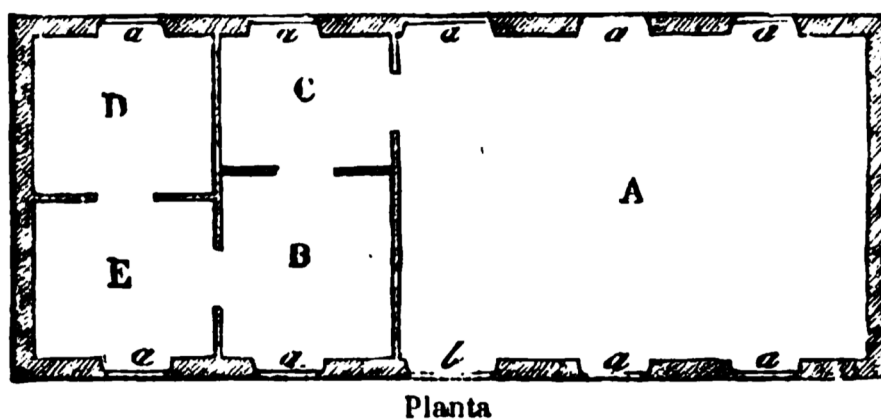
Planta da Casa para Escola Rural – (Ghira, 1864)
